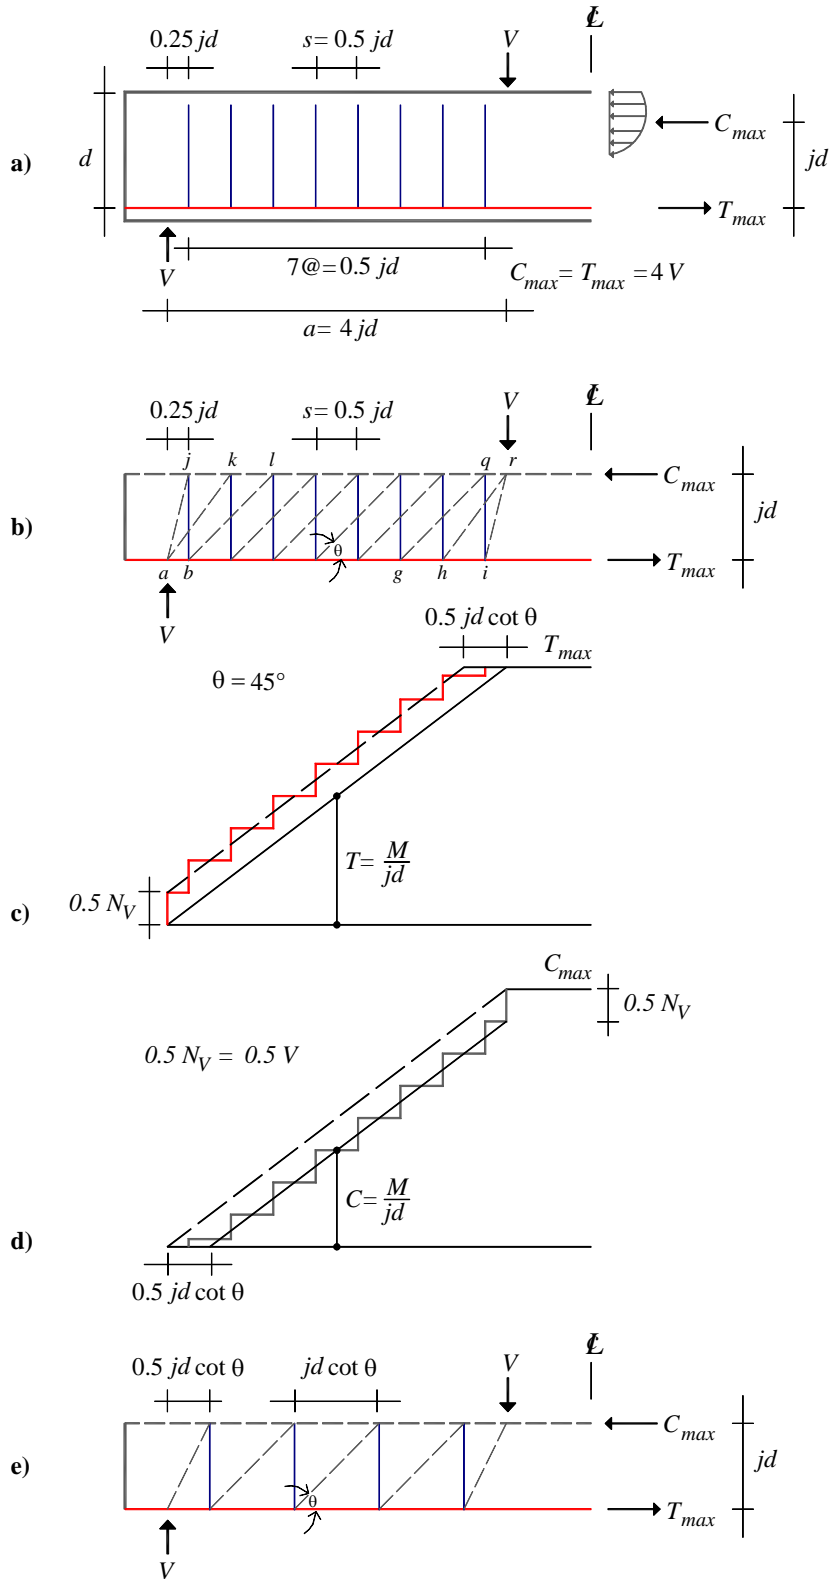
Modelo de armadura plástica: a) claro de cortante, b) modelo completo, c) fuerzas en la cuerda inferior (acero de refuerzo longitudinal), d) fuerzas en la cuerda superior (bloque de concreto) y, e) modelo simplificado equivalente
